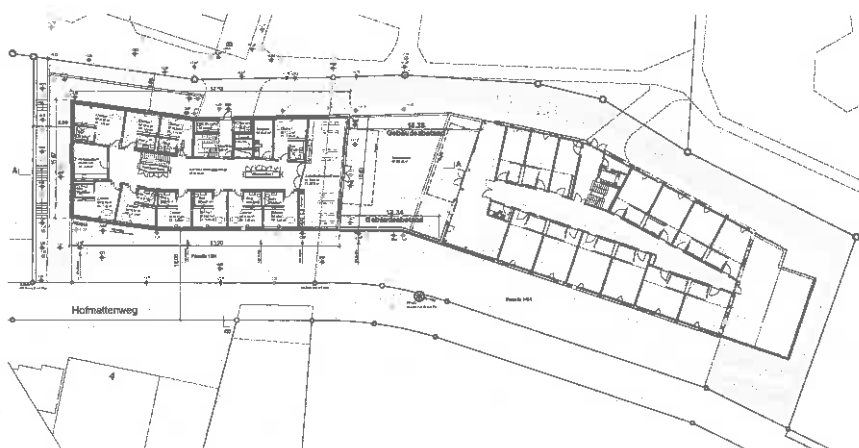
Situation Vorprojekt mit möglichem Gebäudegrundriss innerhalb der Baubereiche für den Sockelbau und für die Hauptgebäude.
